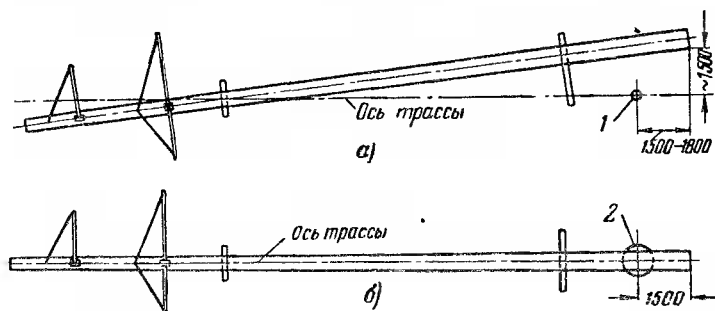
Выкладка железобетонных промежуточных опор для подъема краном КЛЭП-7.
